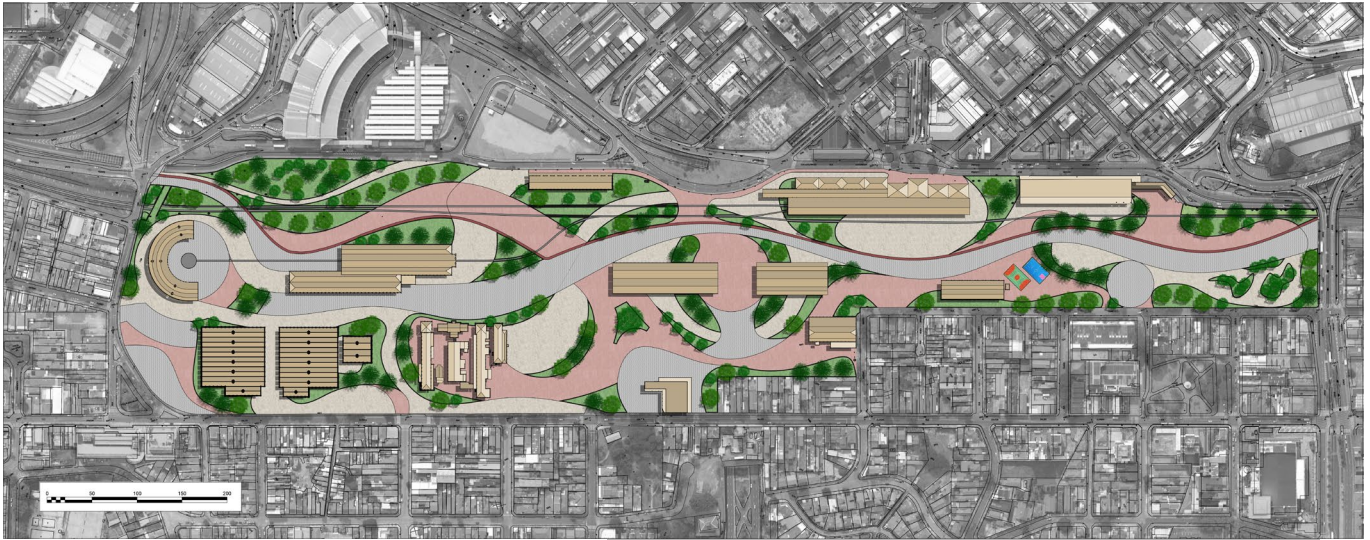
Implantação Geral / Fonte: Autoria do grupo.
